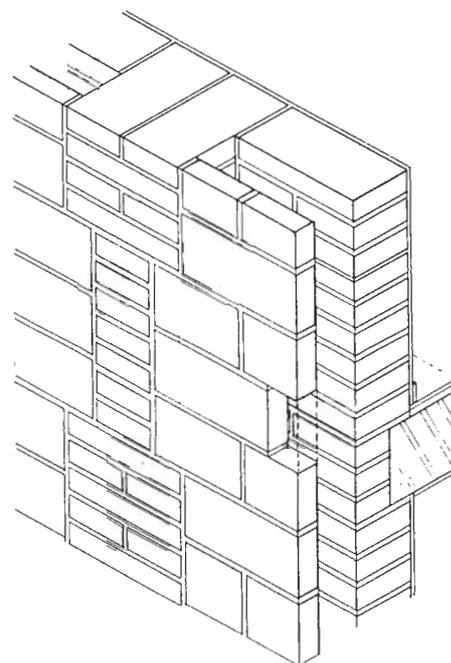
El tabique pluvial, primera hoja exterior libremente dilatada. Esquema de la solución habitual con apoyo en manchones de la medianería.
